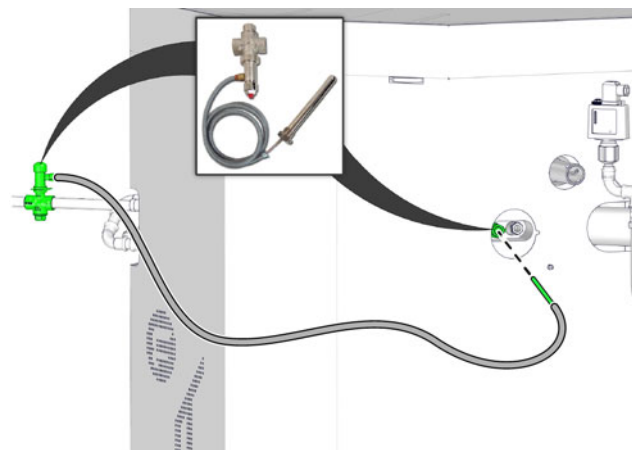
Tube capillaire du dispositif de soupape thermique
